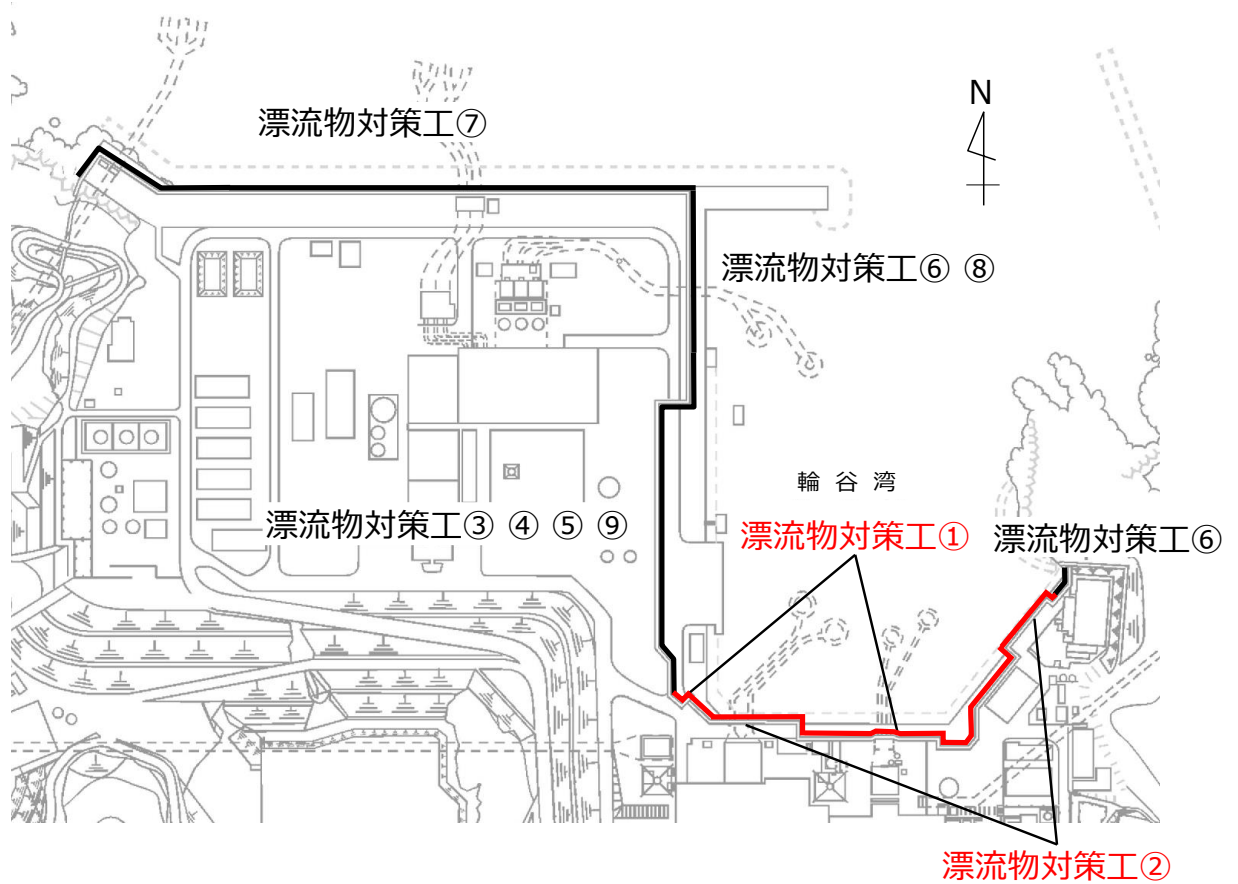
漂流物対策工（鉄筋コンクリート版）の構造区分図
